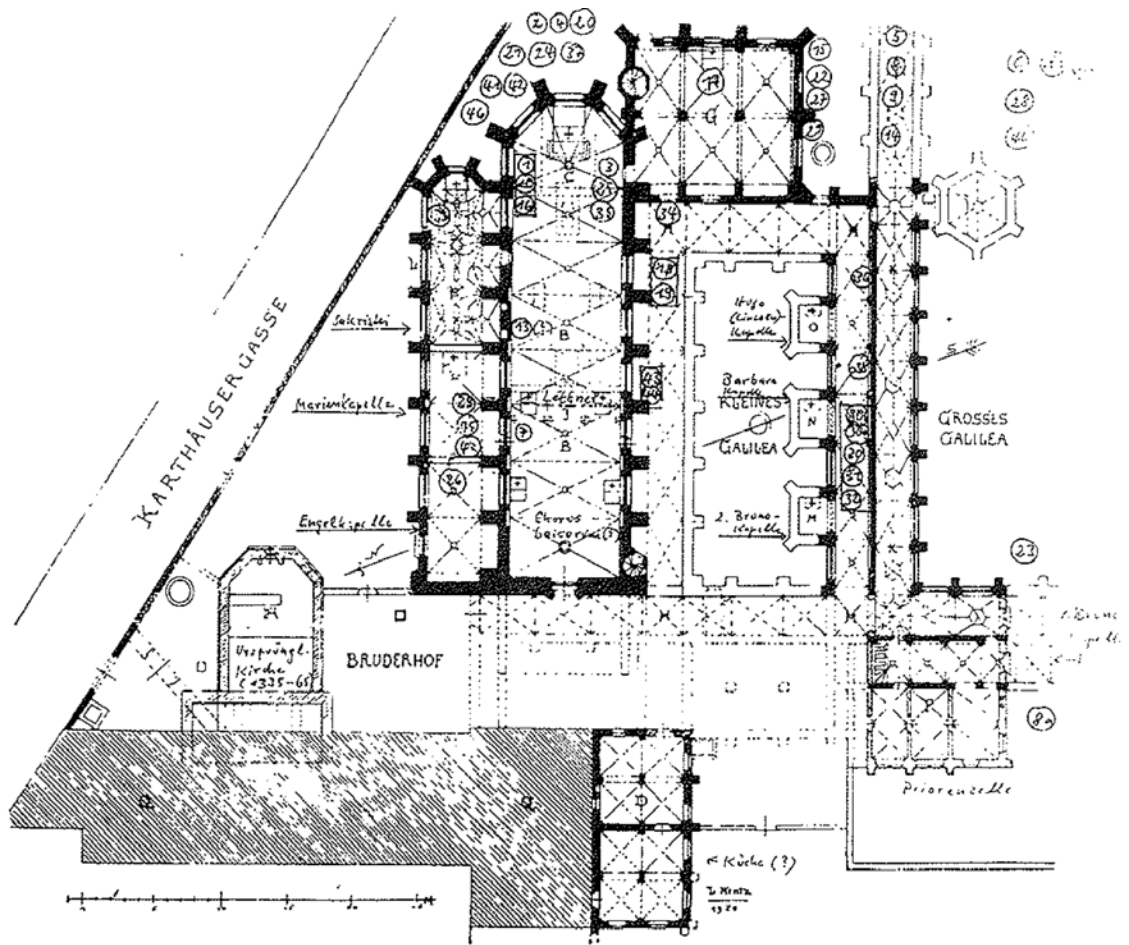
Werner Beutler – Grundriss der Kartause St. Barbara auf Basis der Rekonstruktion nach L. Arntz mit Ergänzungen
